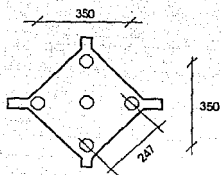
VISTA EN PLANTA DEL DADO D-1
